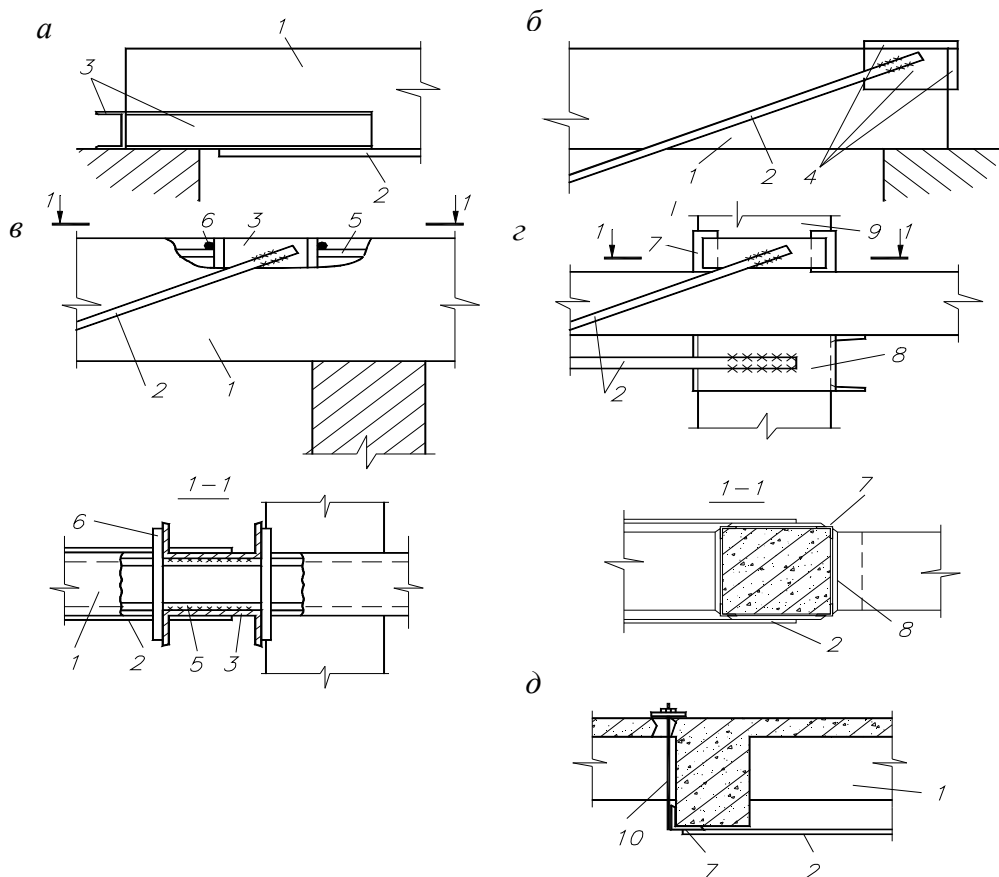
Конструкция анкерных устройств: 1 – усиливаемая конструкция, 2 – затяжка, 3 – швеллер, 4 – лист, 5 – оголенная арматура конструкции, 6 – соединительный стержень, 7 – уголок, 8 – лист, 9 – колонна, 10 – держатель анкера
